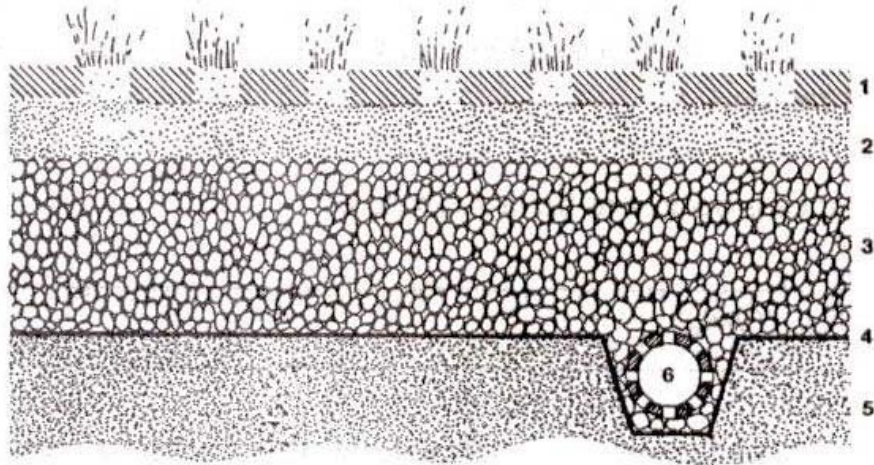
Tubería perforada para funcionar como dren. 1.- Pavimento, 2.- Filtro de arena, 3.- Subbase, 4.- Membrana impermeable, 5.- Subrasante, 6.- Tubería perforada o dren, 7.- Geotextil.
